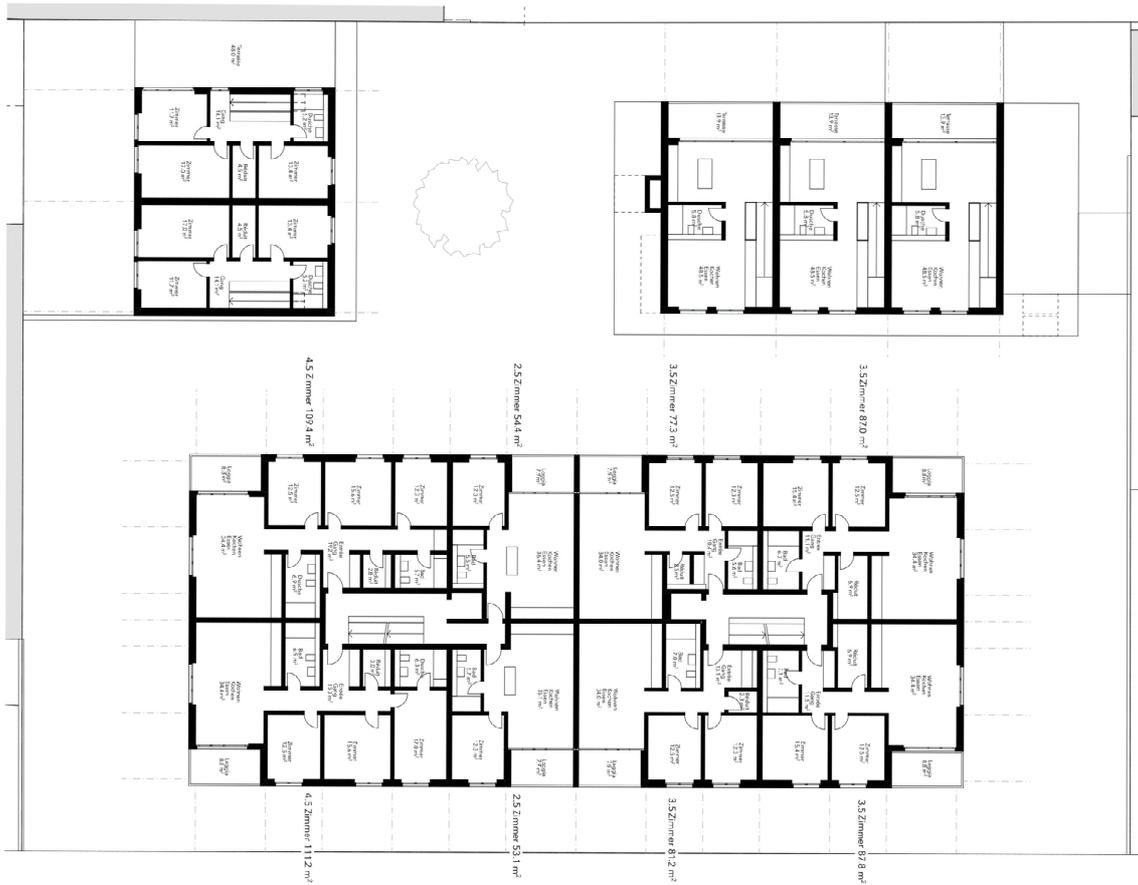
FaBiLe: Grundriss 2. OG
